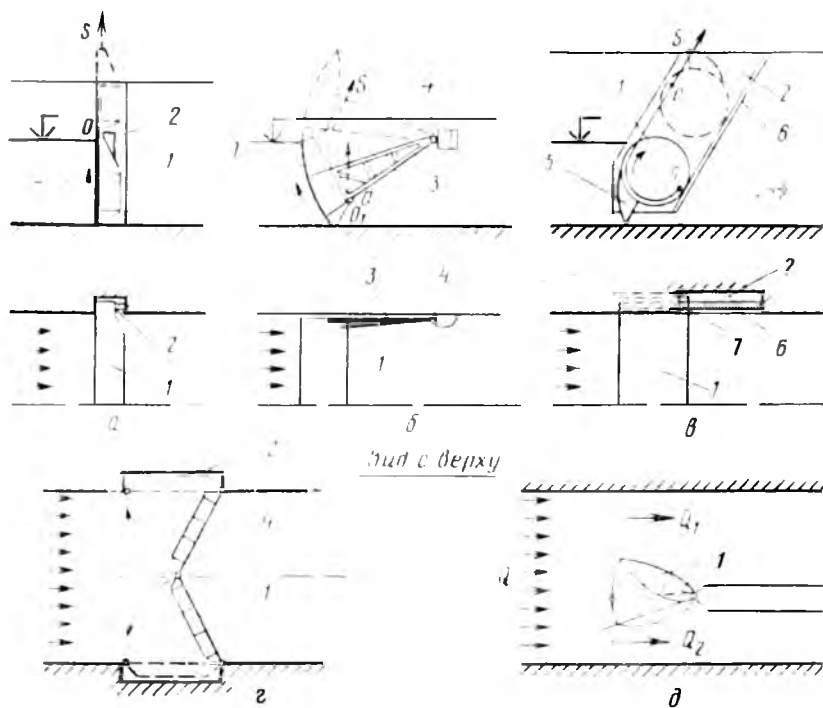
Схемы затворов, передающих нагрузки на быки и устои:
